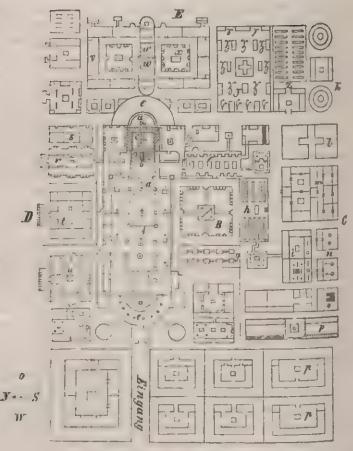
Grundriss des Mlosters S. Gallen.
